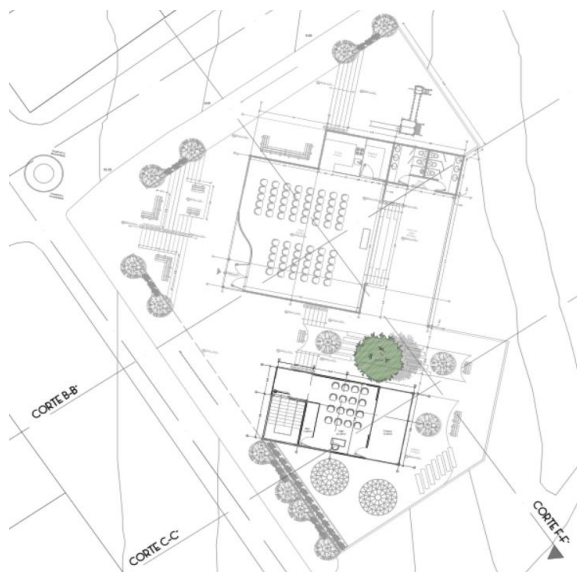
Planta de Segundo Nivel Proyecto Salón Social las Margaritas.
